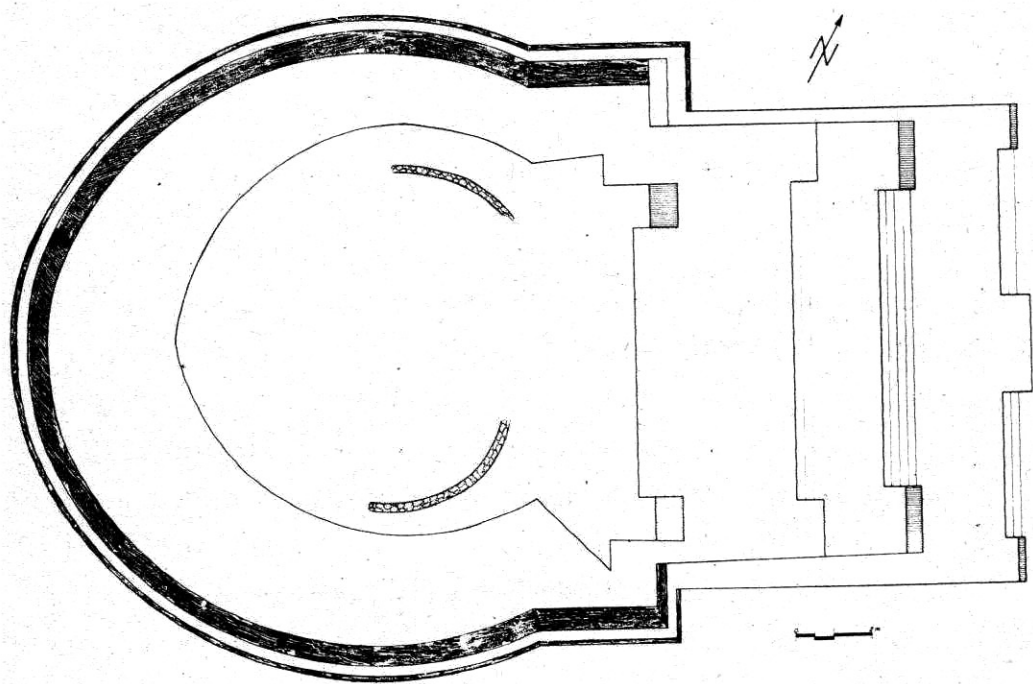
Planta Edificio núm 51 dedicado a Ehecatl. Lev. Alejandro Arenas Villalón
